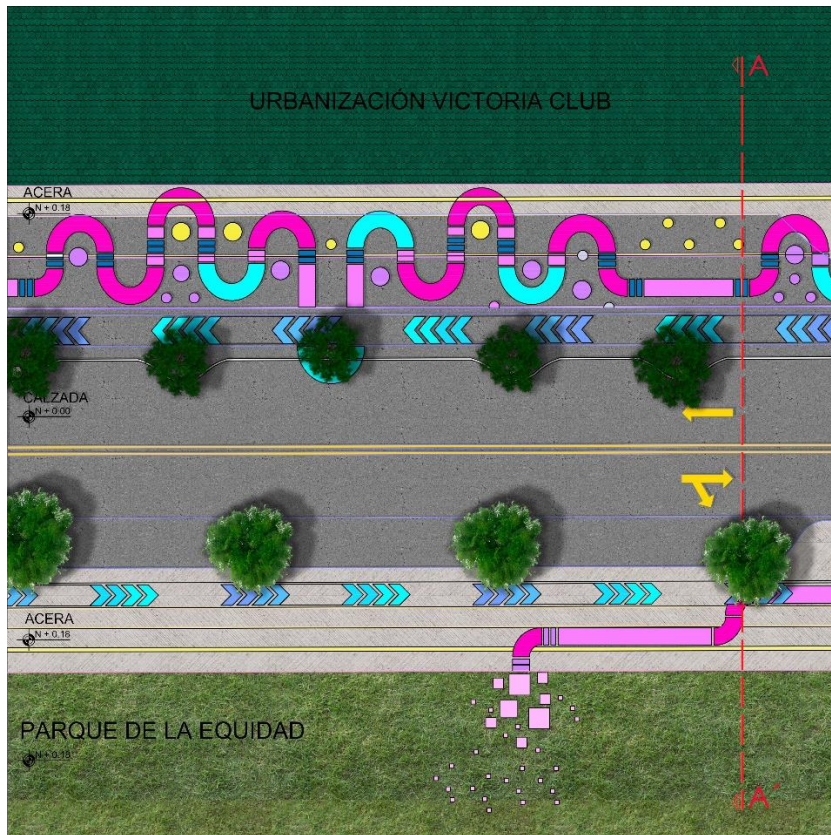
Implantación Tipológica Tramo 1, sección A-A'.
